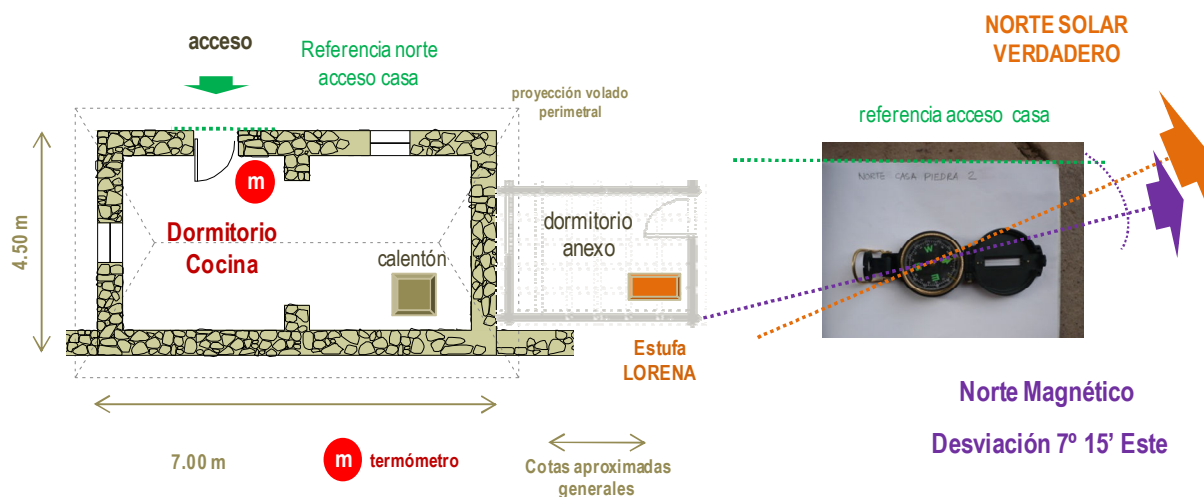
Ficha individual 3: Imágenes y detalles PIEDRA I.
